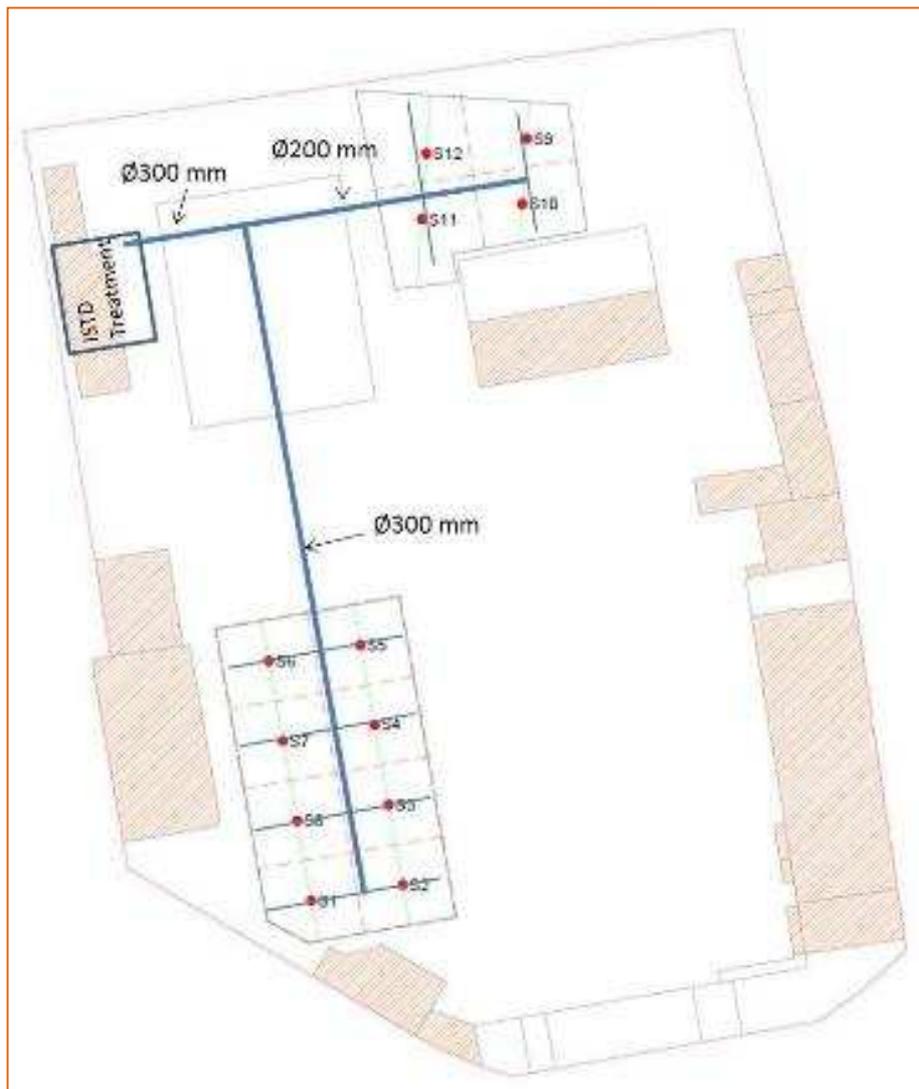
Posizione del collettore principale e dell'impianto di trattamento ISTT
